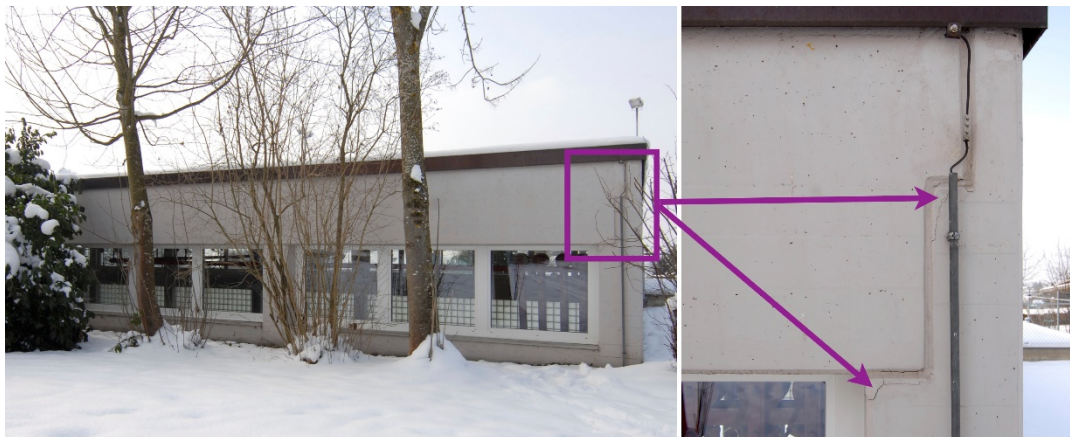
Tremblement de terre de Zoug en 2012. Gymnase à Allenwinden dans le canton de Zoug présentant de fines fissures le long du support de la poutre de toit en béton armé :
